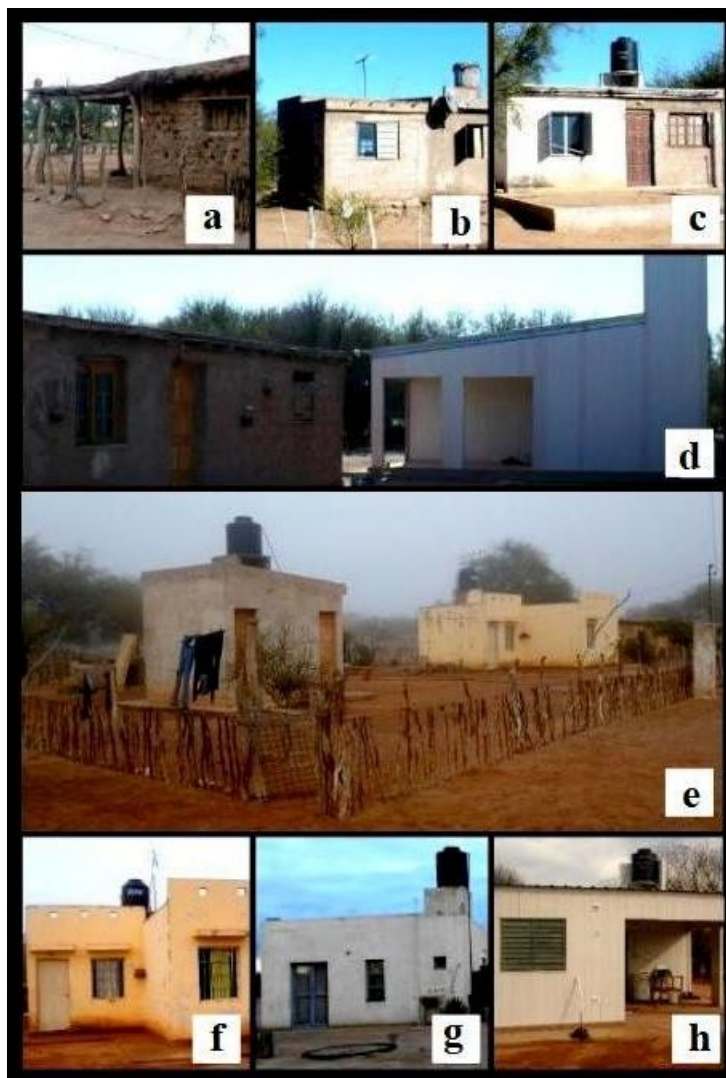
A. Características Físicas de la Vivienda. Tipología de la Vivienda, (Material de Construcción predominante): a, b, c: Viviendas Tradicionales, (a: paredes de adobe y techo con una estructura de múltiples capas de barro y vegetación local; b, c: paredes de ladrillo cocido revocado con cemento).
